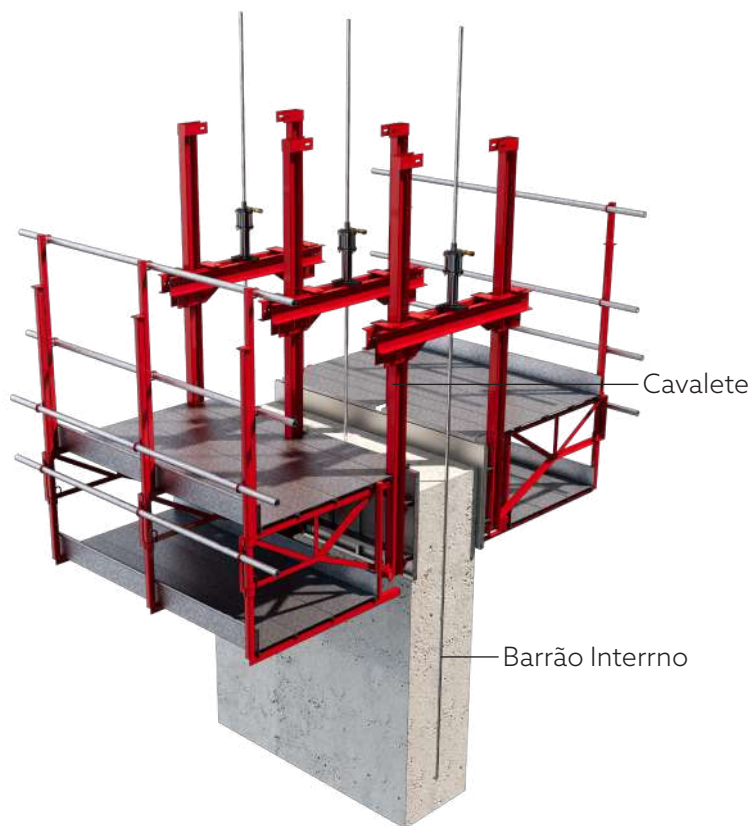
Fôrma deslizante com cavalete, com barrão interno, ou sem treliças
